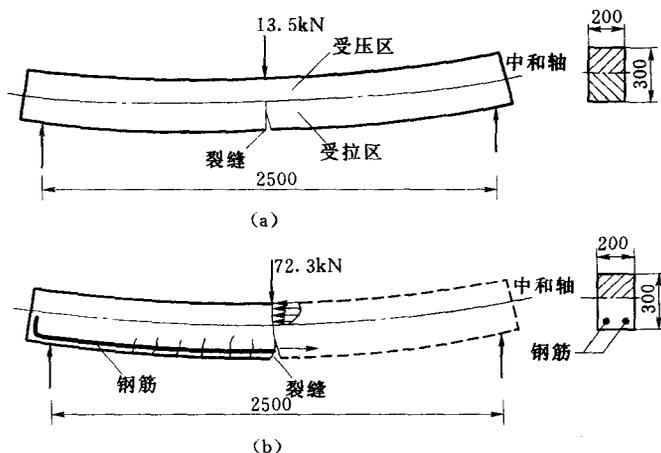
混凝土梁、钢筋混凝土梁的承载力试验
